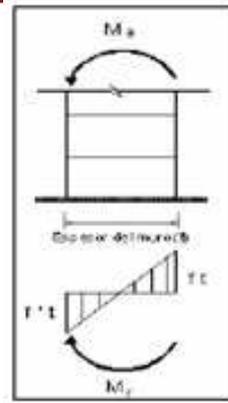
Momento resistente M_r en un muro de albañilería
